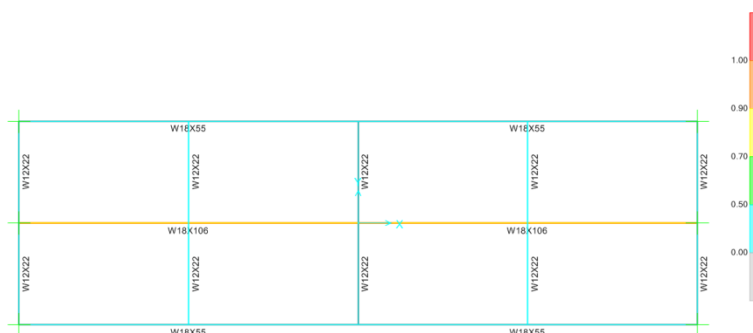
Planta de diseño de puente con detalle de perfiles utilizados
